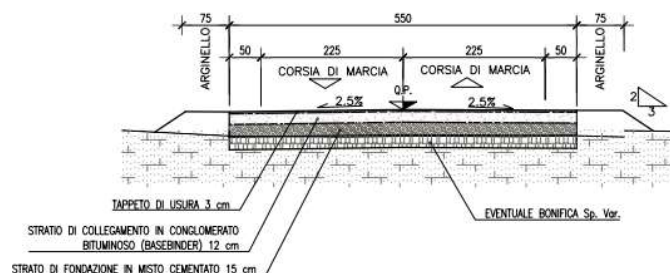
Sezione tipo complanare 5,5 m in rilevato
